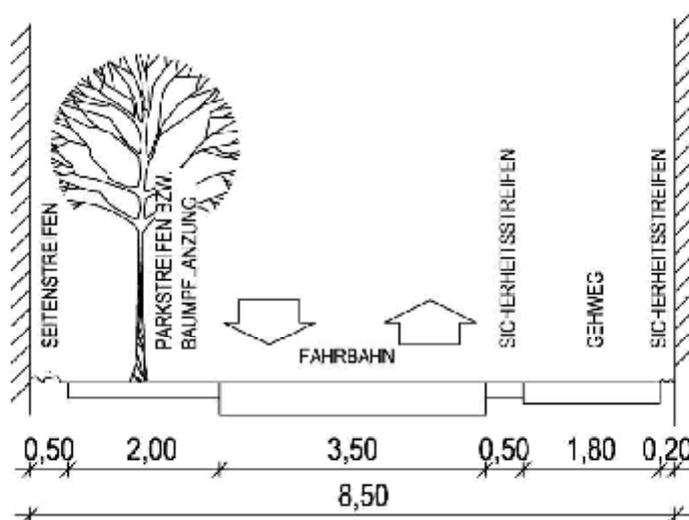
Straßenquerschnitt reduziert – mit Parkstreifen bzw. Baumpflanzungen
